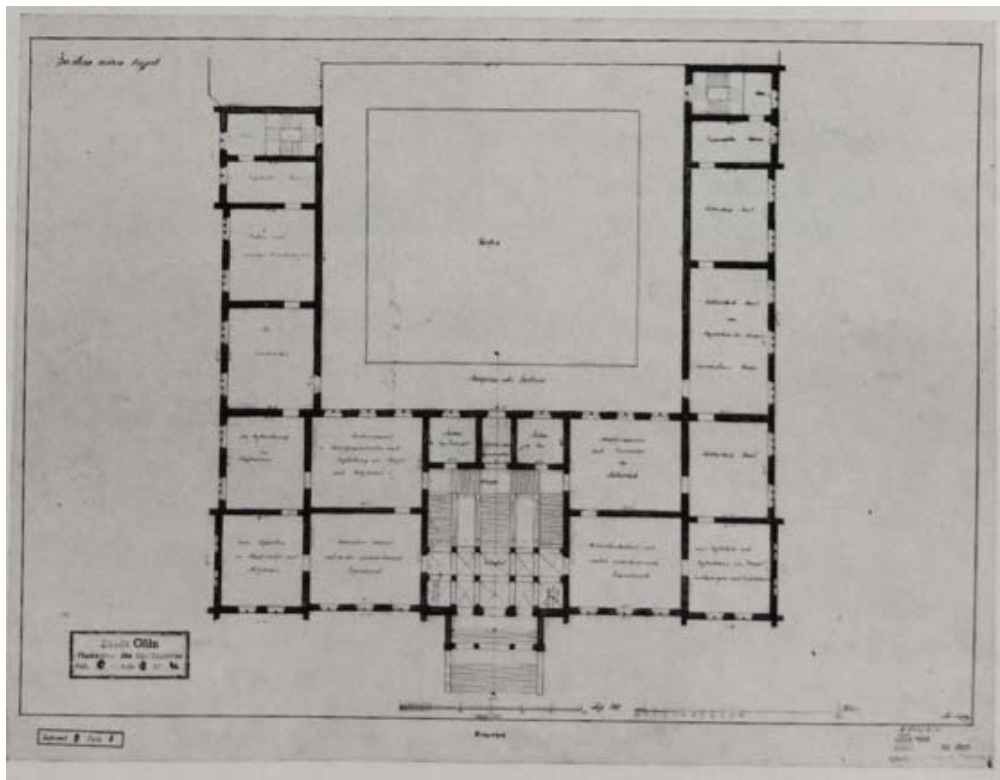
Josef Felten – Entwurf für das Wallraf-Richartz-Museum – Grundriss
